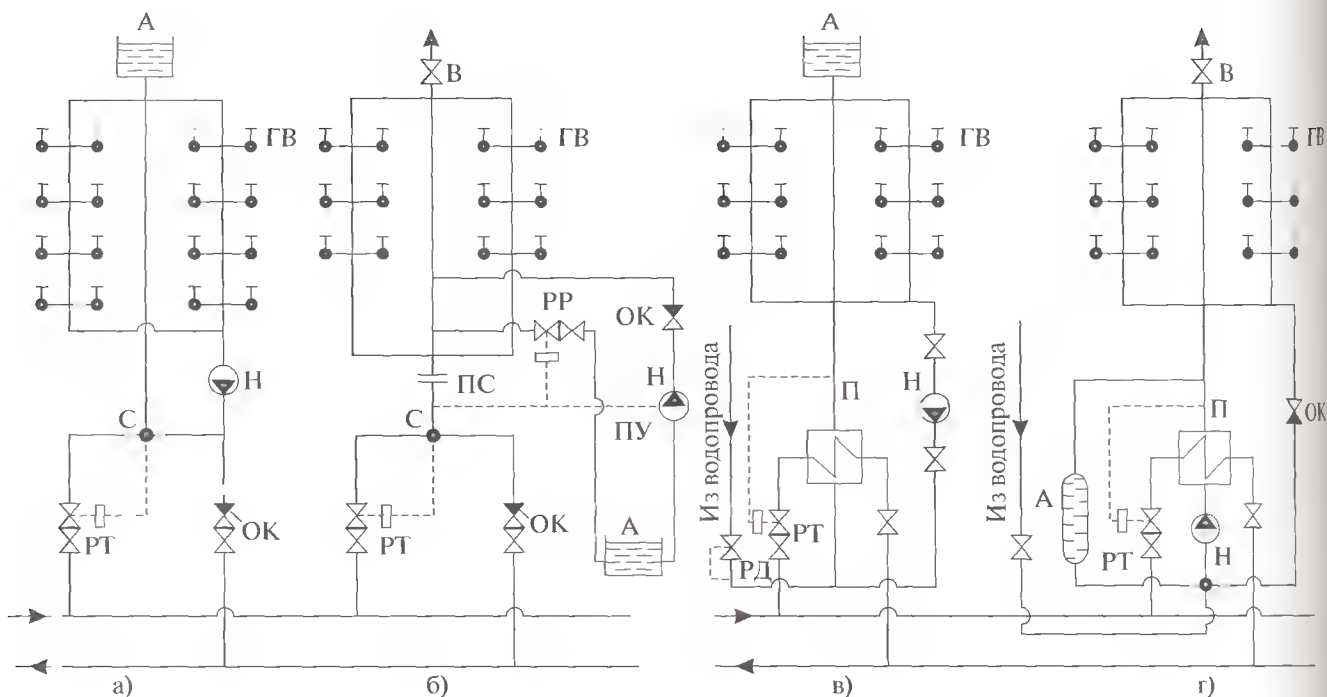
Схемы присоединения установок горячего водоснабжения к тепловым сетям:
